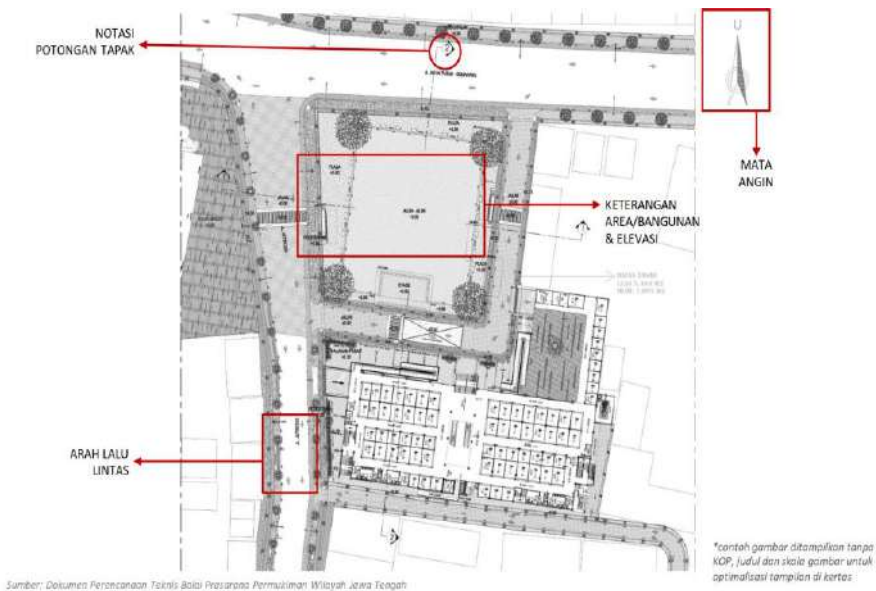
Contoh Gambar Rencana Massa Bangunan (*Block Plan*)
